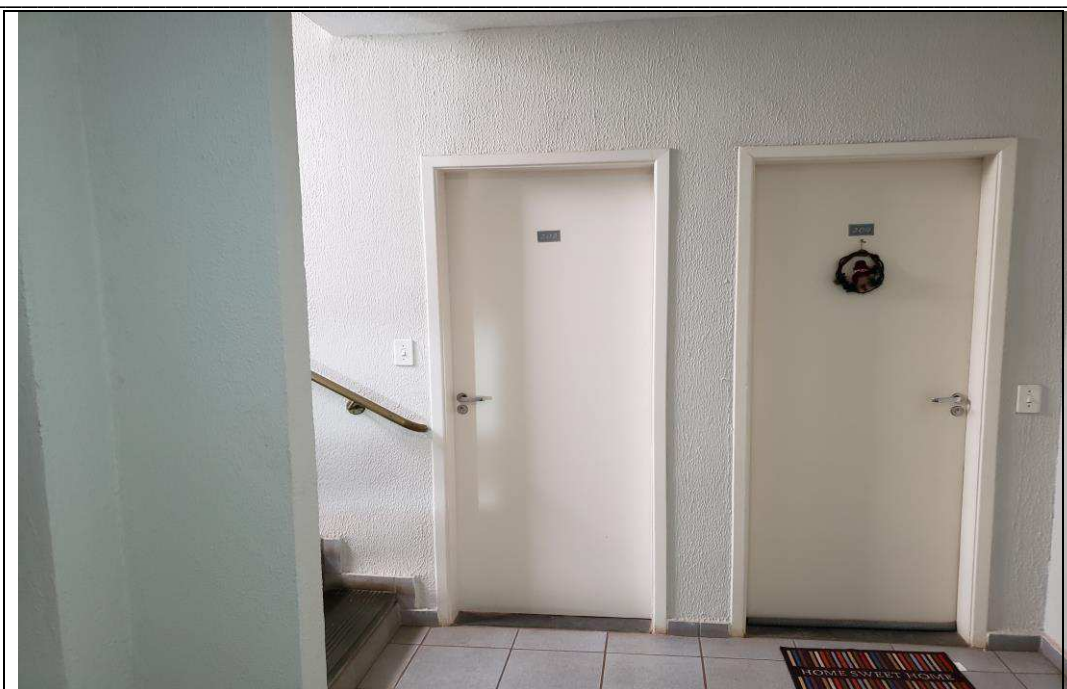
Vista da porta frontal do apartamento (nº203).
